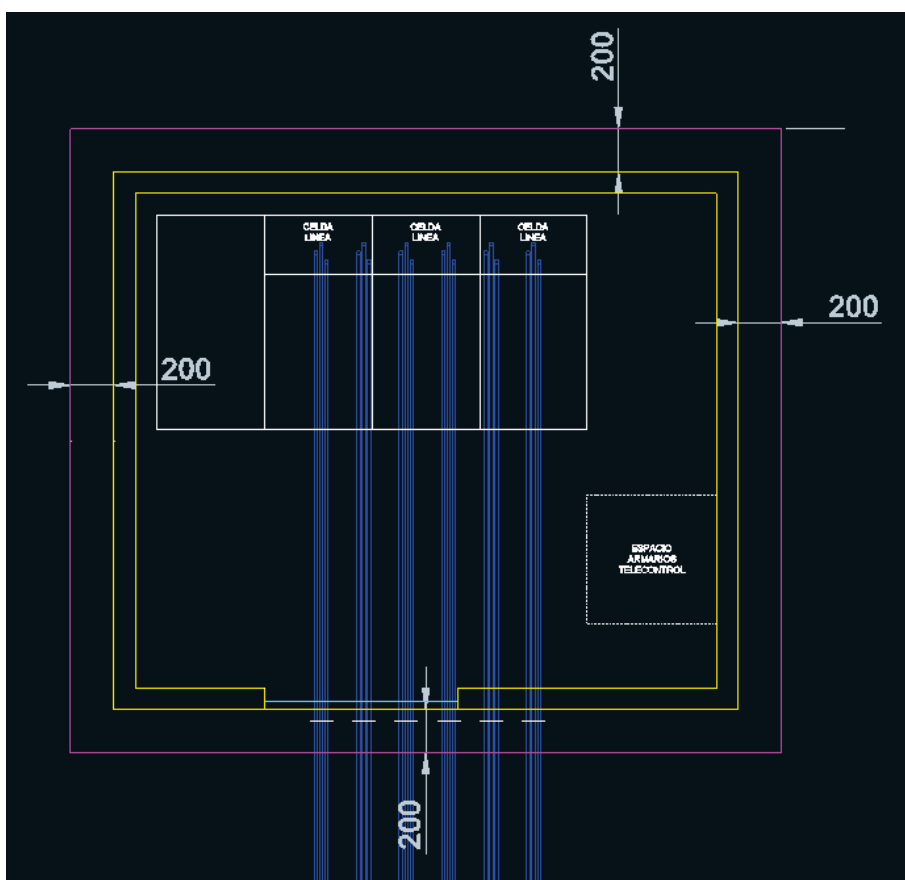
Vista en planta de la instalación (3L [Sup]) (cotas en mm).
